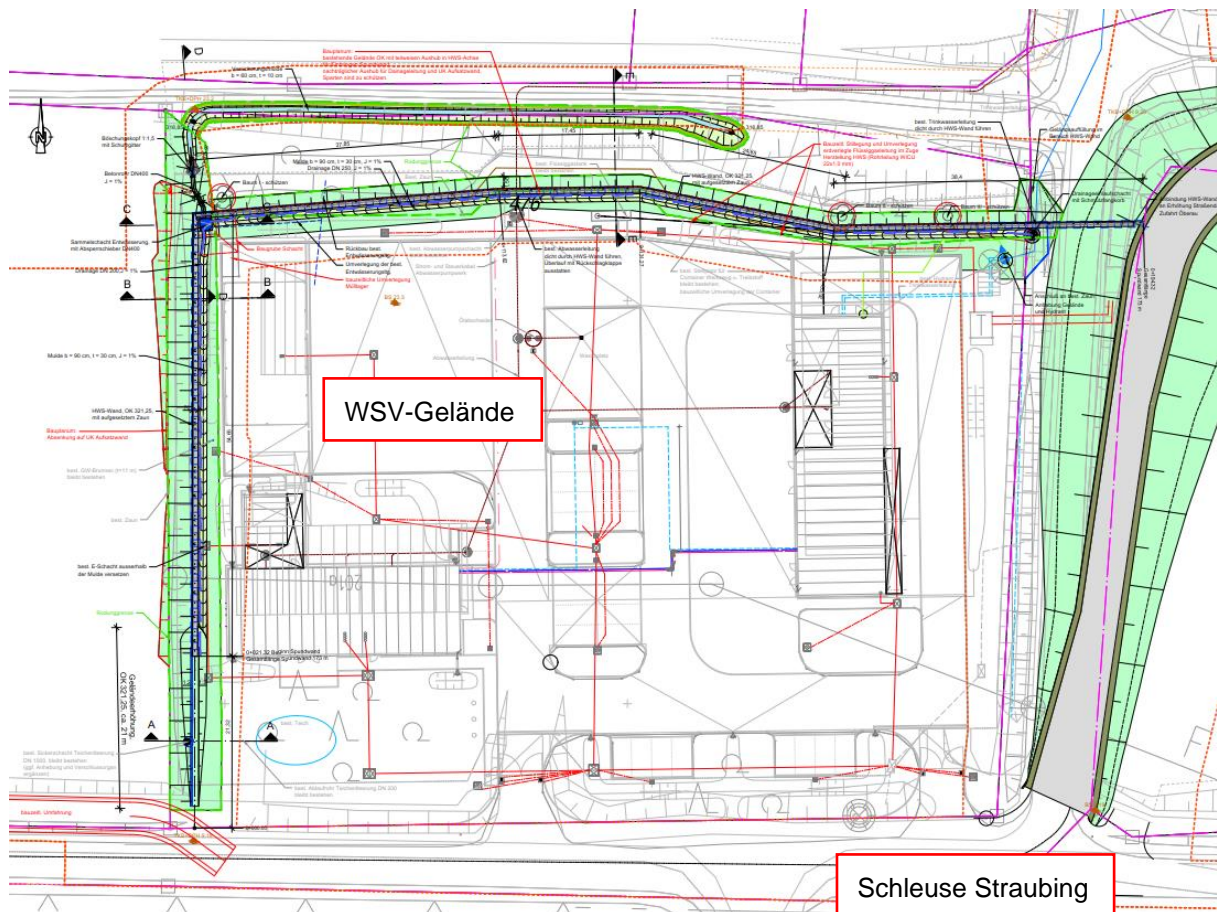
Deichabschnitt 4, Detaillageplan (aus Plan 04-07-01)
